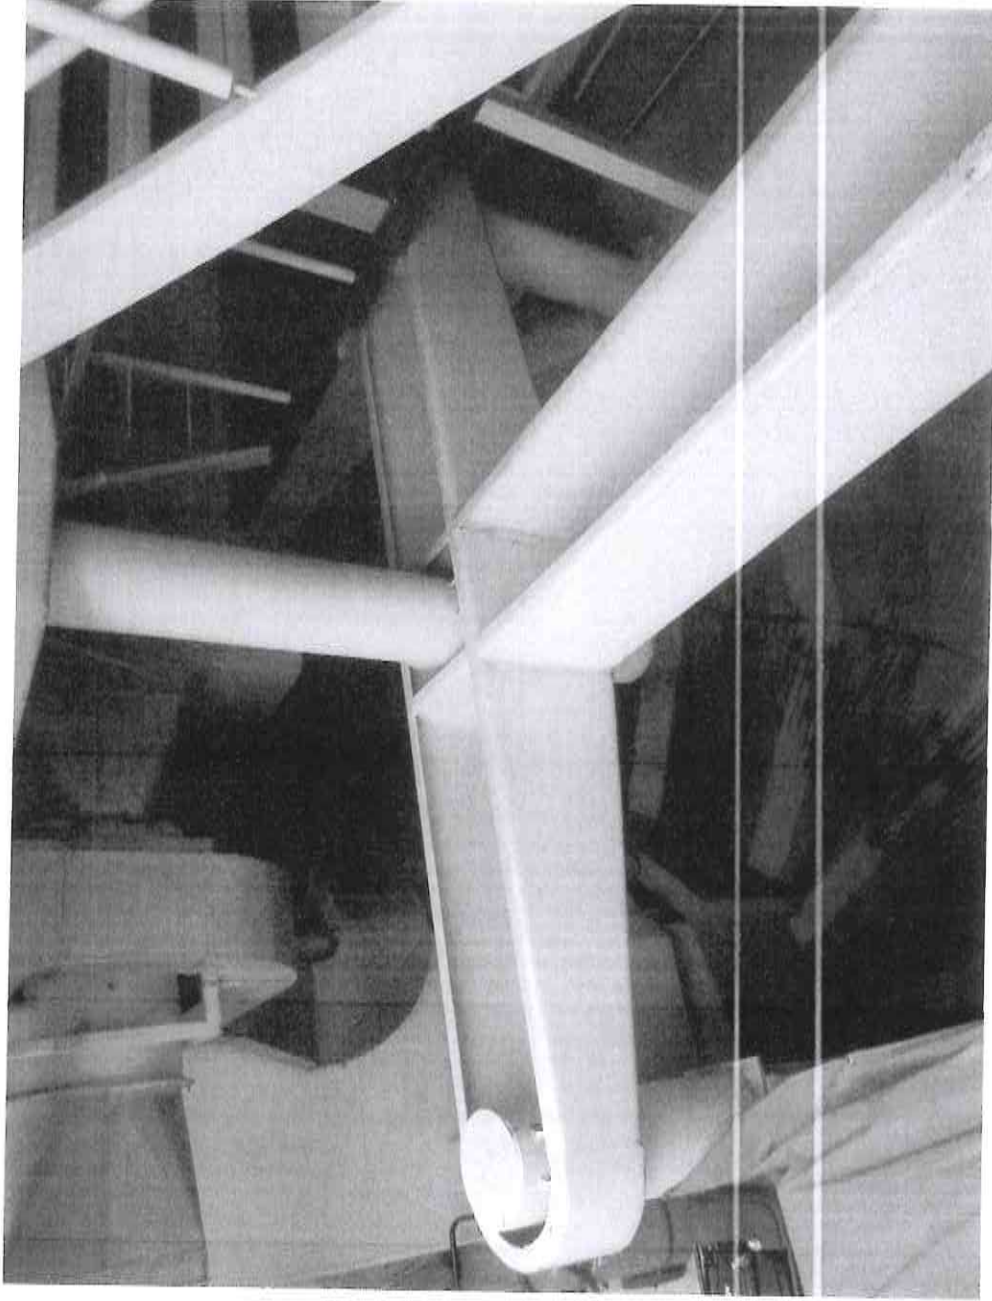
Placa Base de estructura de cubo de escalera de emergencia
